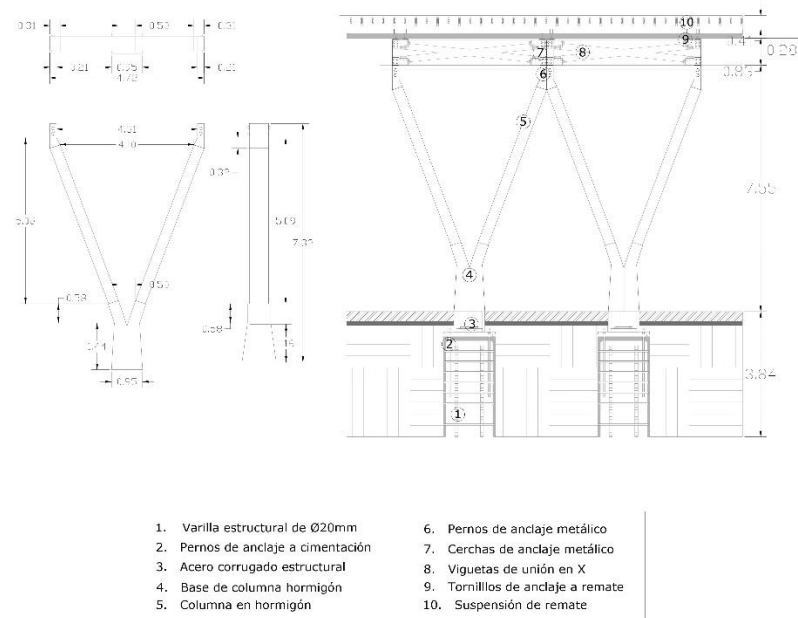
Detalle Columnas de apoyo en algunas zonas del proyecto, evidenciando la estructura interna y su anclaje a la edificación.
